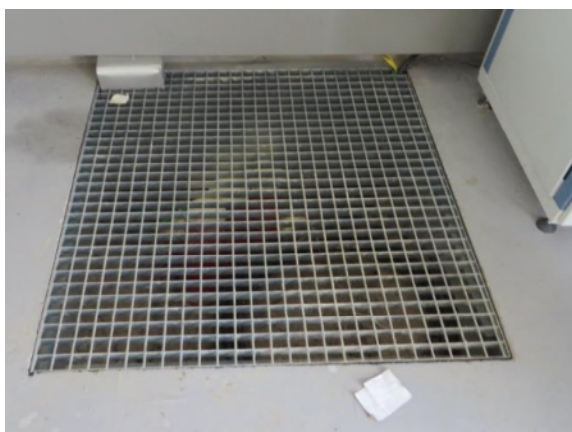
Vista de la arqueta interior de entrada a cableado de RTU.
